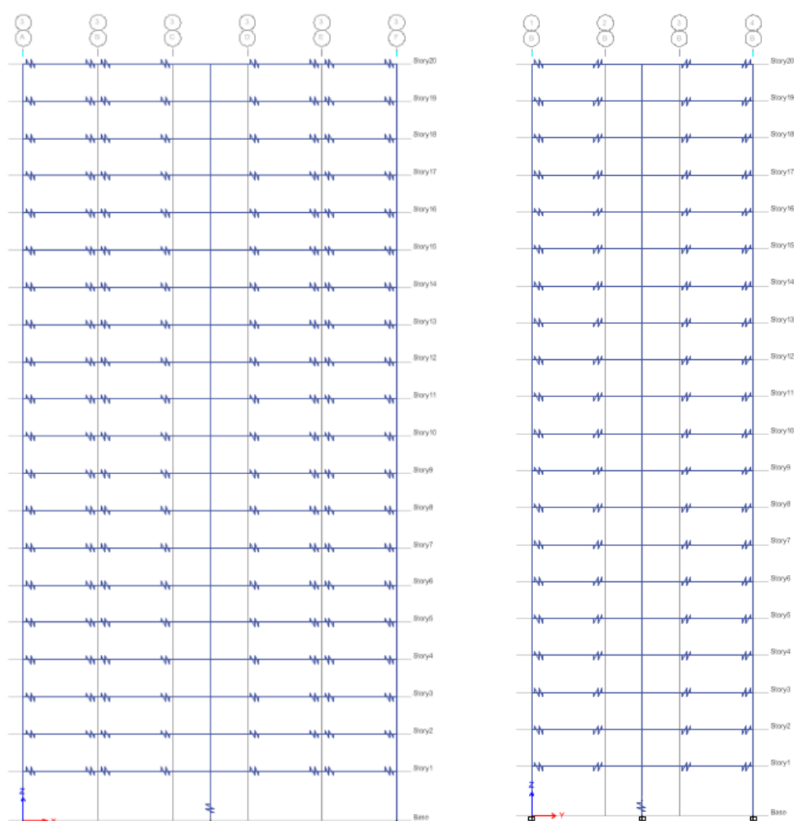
Distribución de rótulas perfectas en elevación estructural auxiliar Edificio Tipo 2
